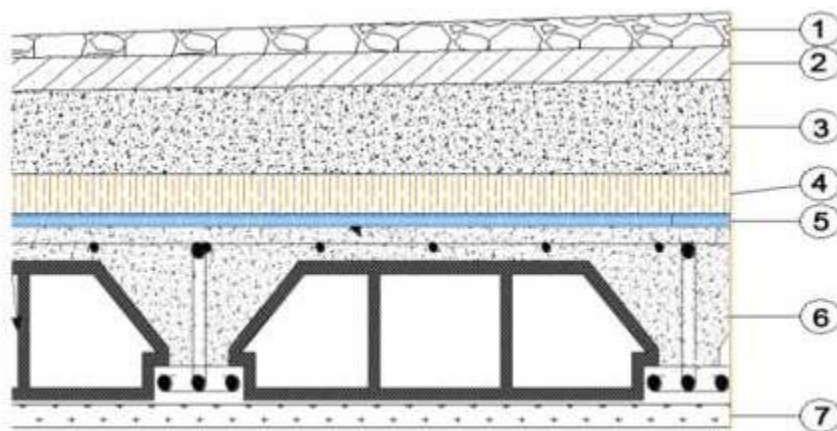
Section du plancher terrasse inaccessible en structure creuse
